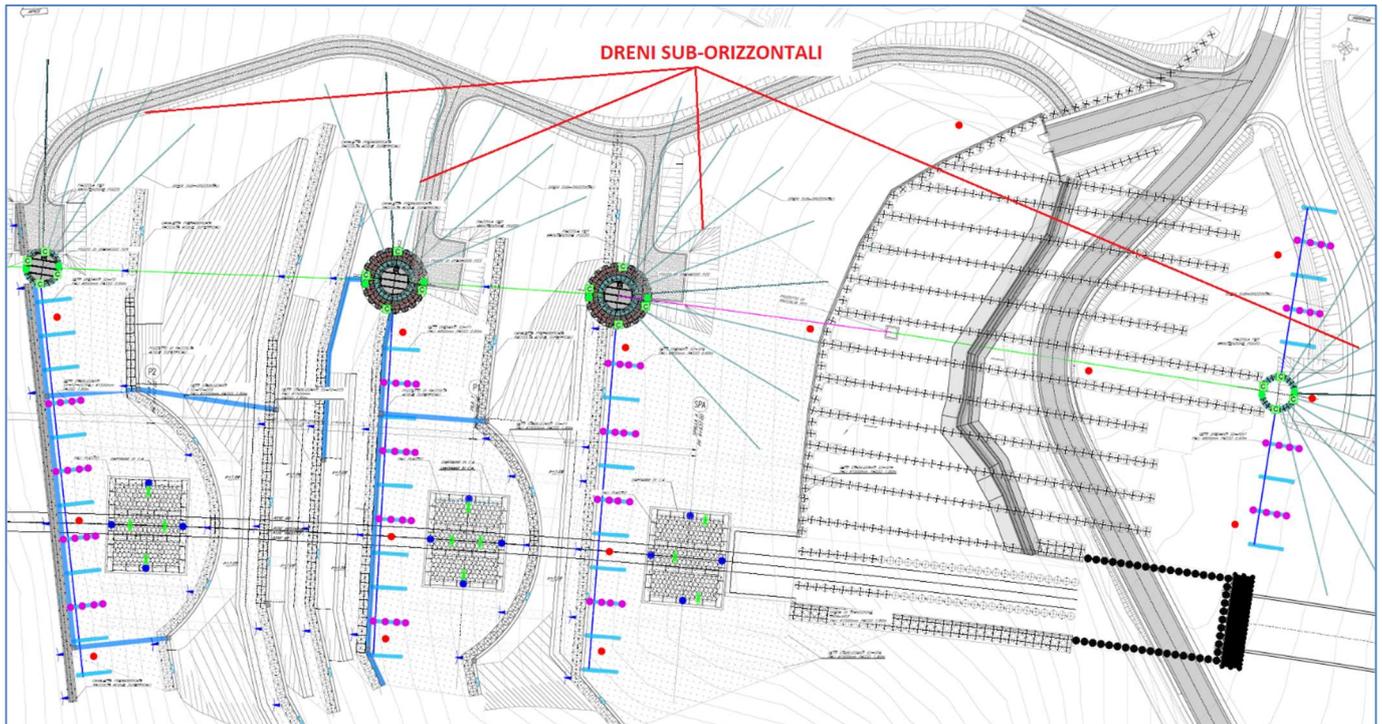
Stralcio Planimetrico con indicazione dei Dreni Sub-Orizzontali dei 4 Pozzi Drenanti
